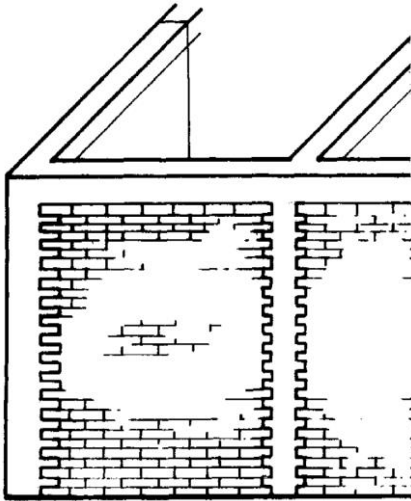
Zuncho o encadenado más refuerzo con contrafuertes.
